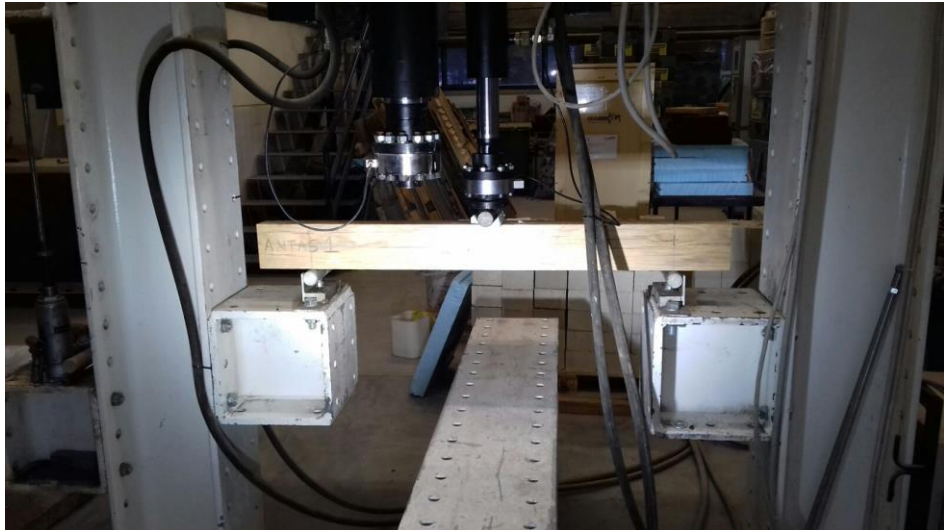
Ensaio Viga Antas 1 (Foto Caçador, 2017)
